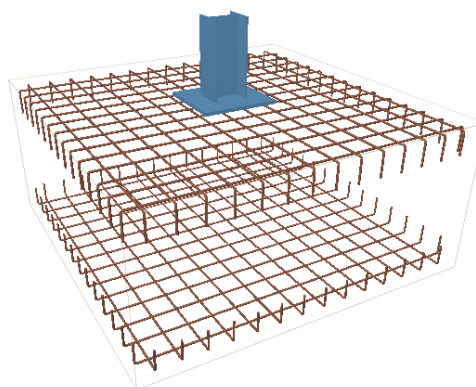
Disposición de las armaduras de la zapata del pórtico interior.
